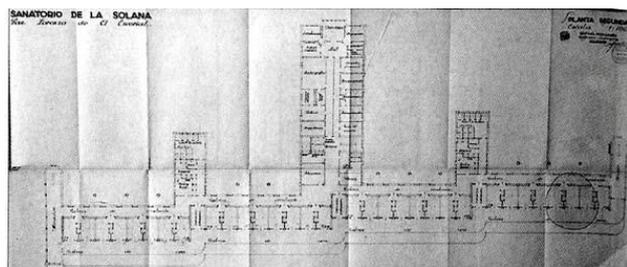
R. Bergamín. Proyecto Sanatorio La Solana, El Escorial, 1934-35. Planta tipo y baja (1935).
